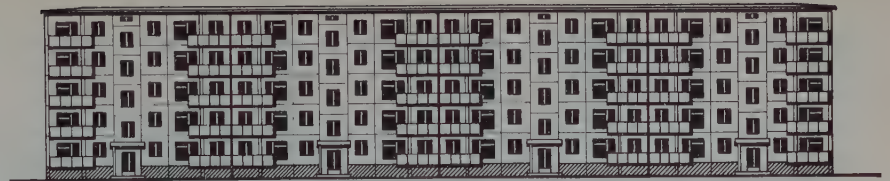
Teilansicht der Fassade eines Großplatten-Wohnhauses mit verlängerten Balkons. Für die Balkonbrüstungen wurde Drahtglas verwendet
